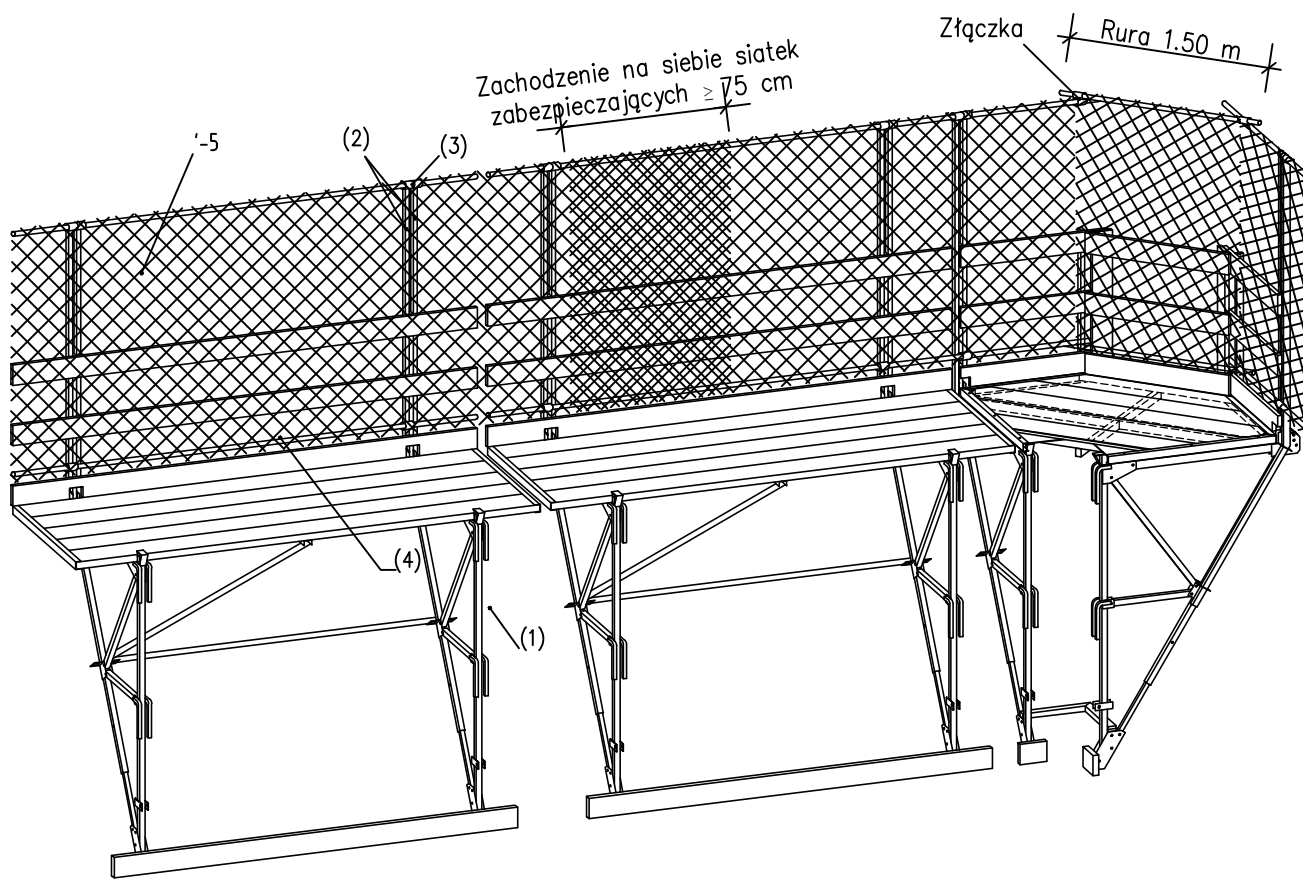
Przekrój rusztowania łapaczy dachowych
